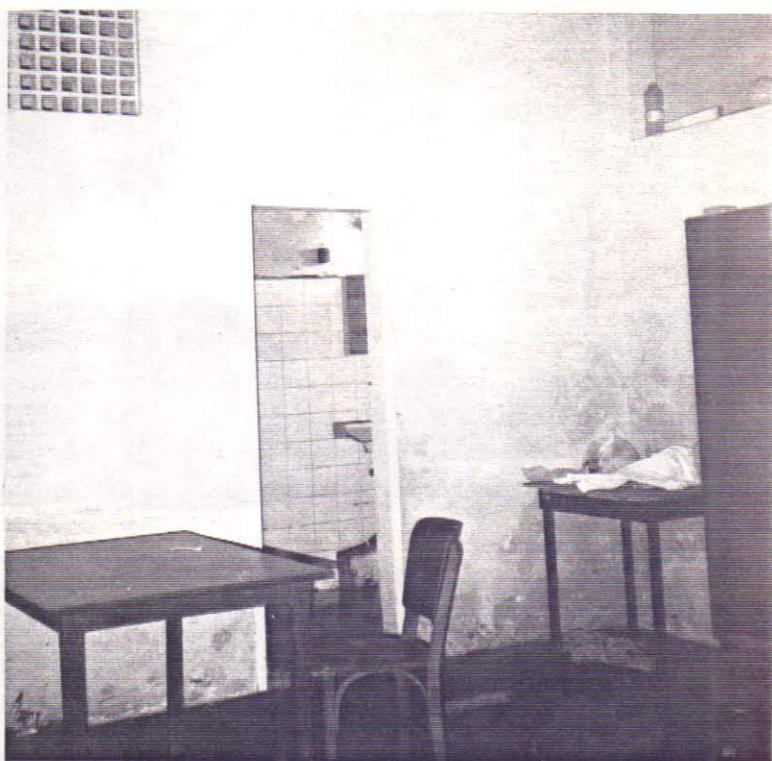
Ambiente subutilizado na REU da Rua Waldery Uchoa, 140. Paredes tomadas pela infiltração.
